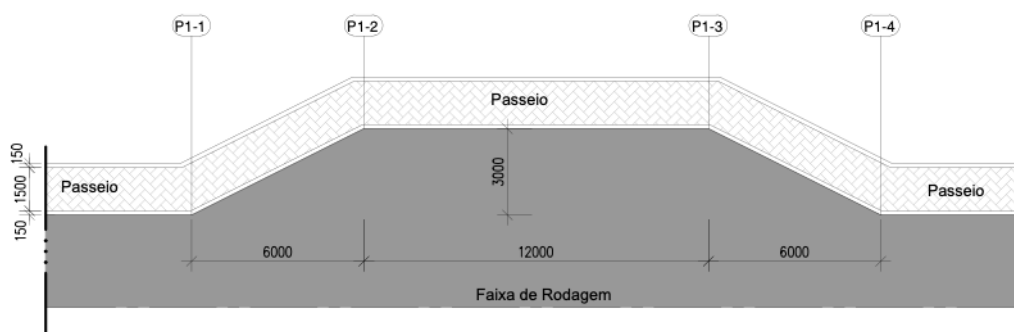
Pormenor da paragem a implantar do lado esquerdo do traçado
